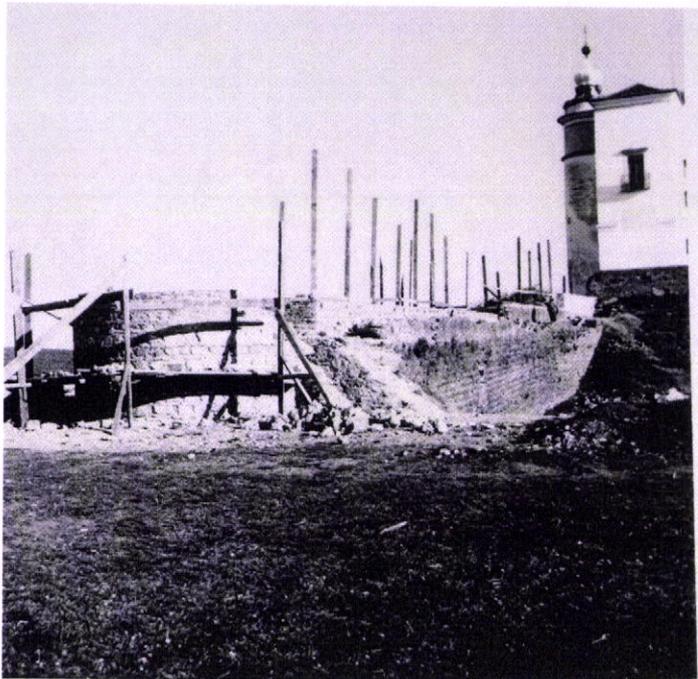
Fortificações de Estremoz. Aspecto da cerca medieval e terreiro (junto da Capela da Rainha Santa Isabel), durante as obras de reconstrução do cubelo do Postigo dos Palhais (16/08/1966) (DREMS 14130)
